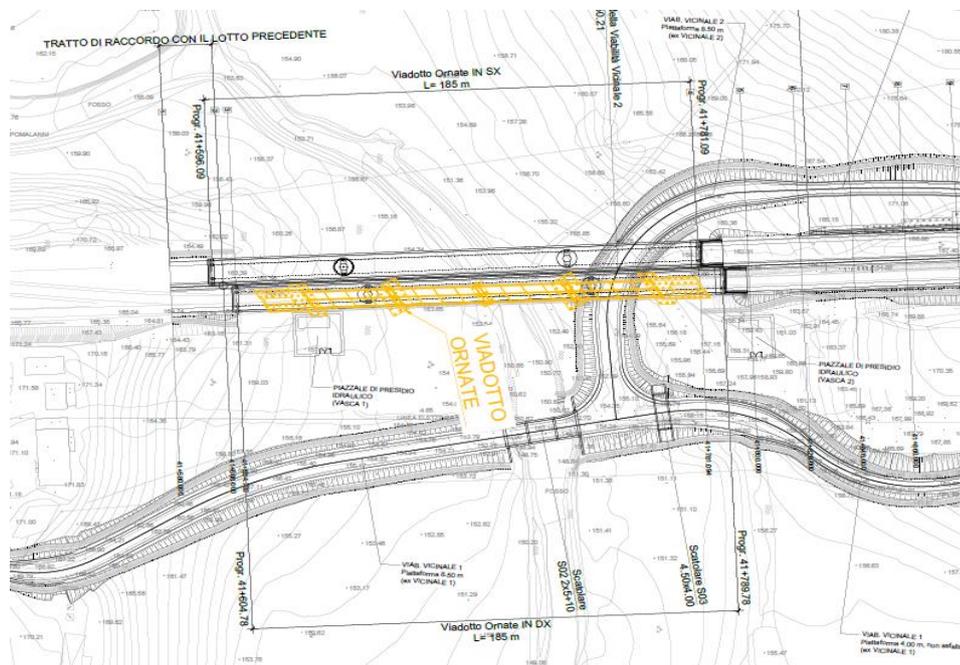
Posizione del viadotto esistente nella planimetria di progetto
